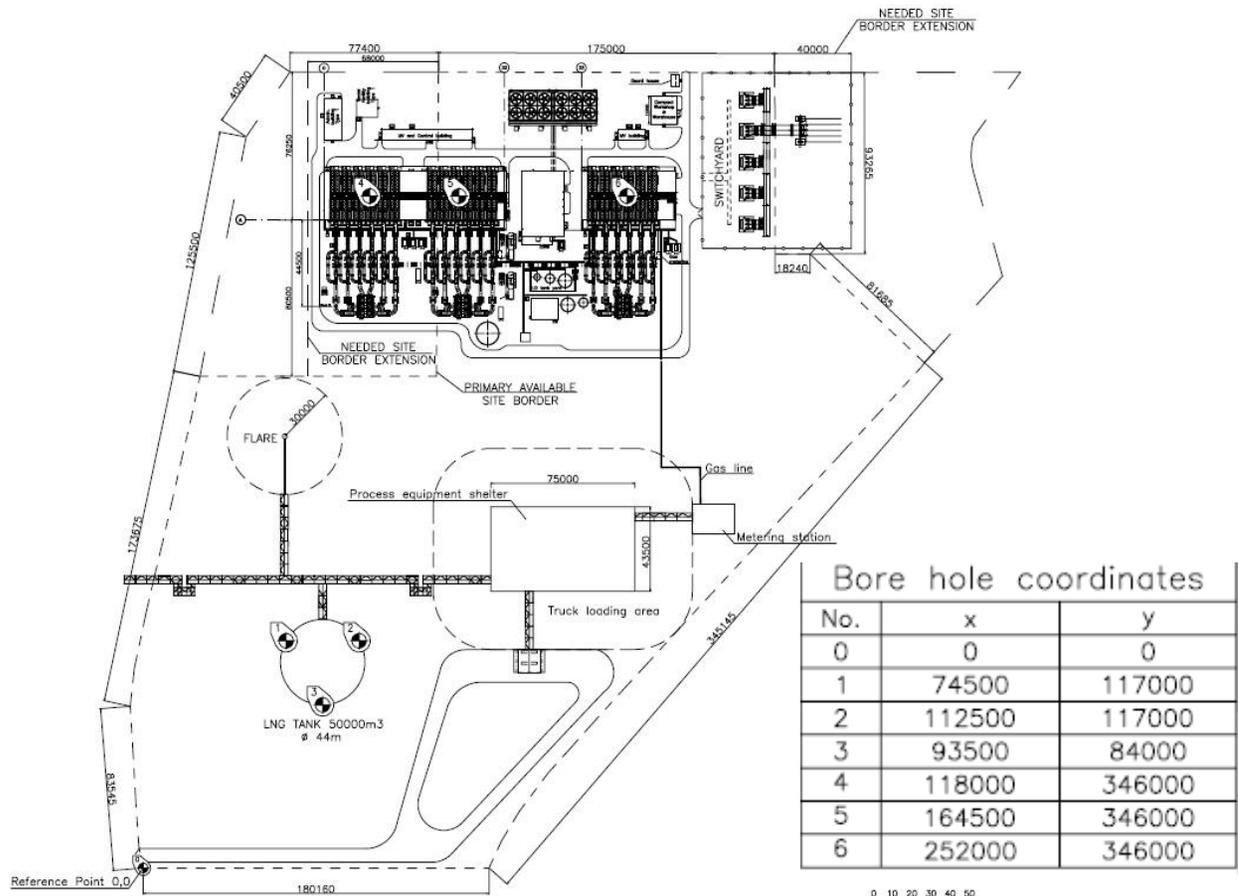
Plan de distribución de pozos propuesto por Wäertsillä
